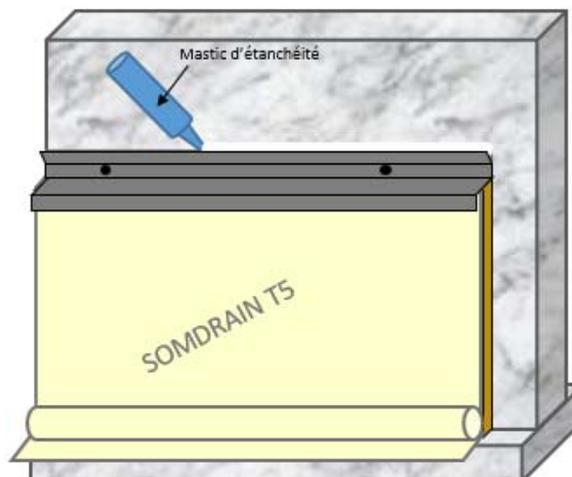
Mise en place du mastic d'étanchéité sur le solin
